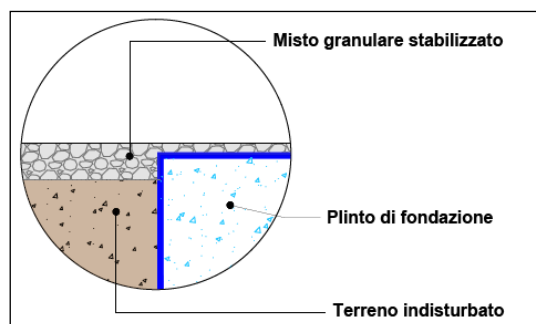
Particolare pavimentazione piazzola tipo in fase di esecuzione lavori
